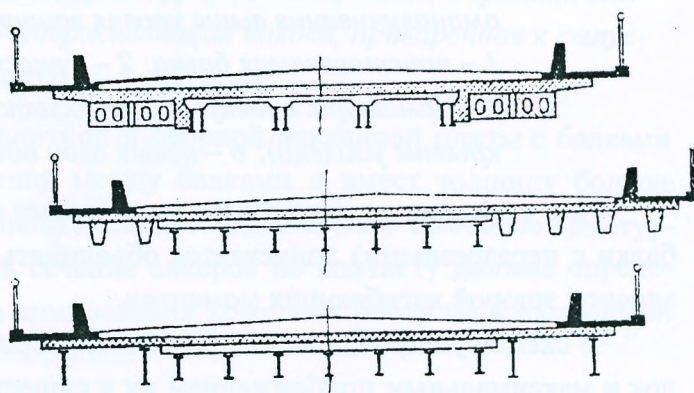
Схемы уширения сталежелезобетонных пролетных строений с прокатными балками.
